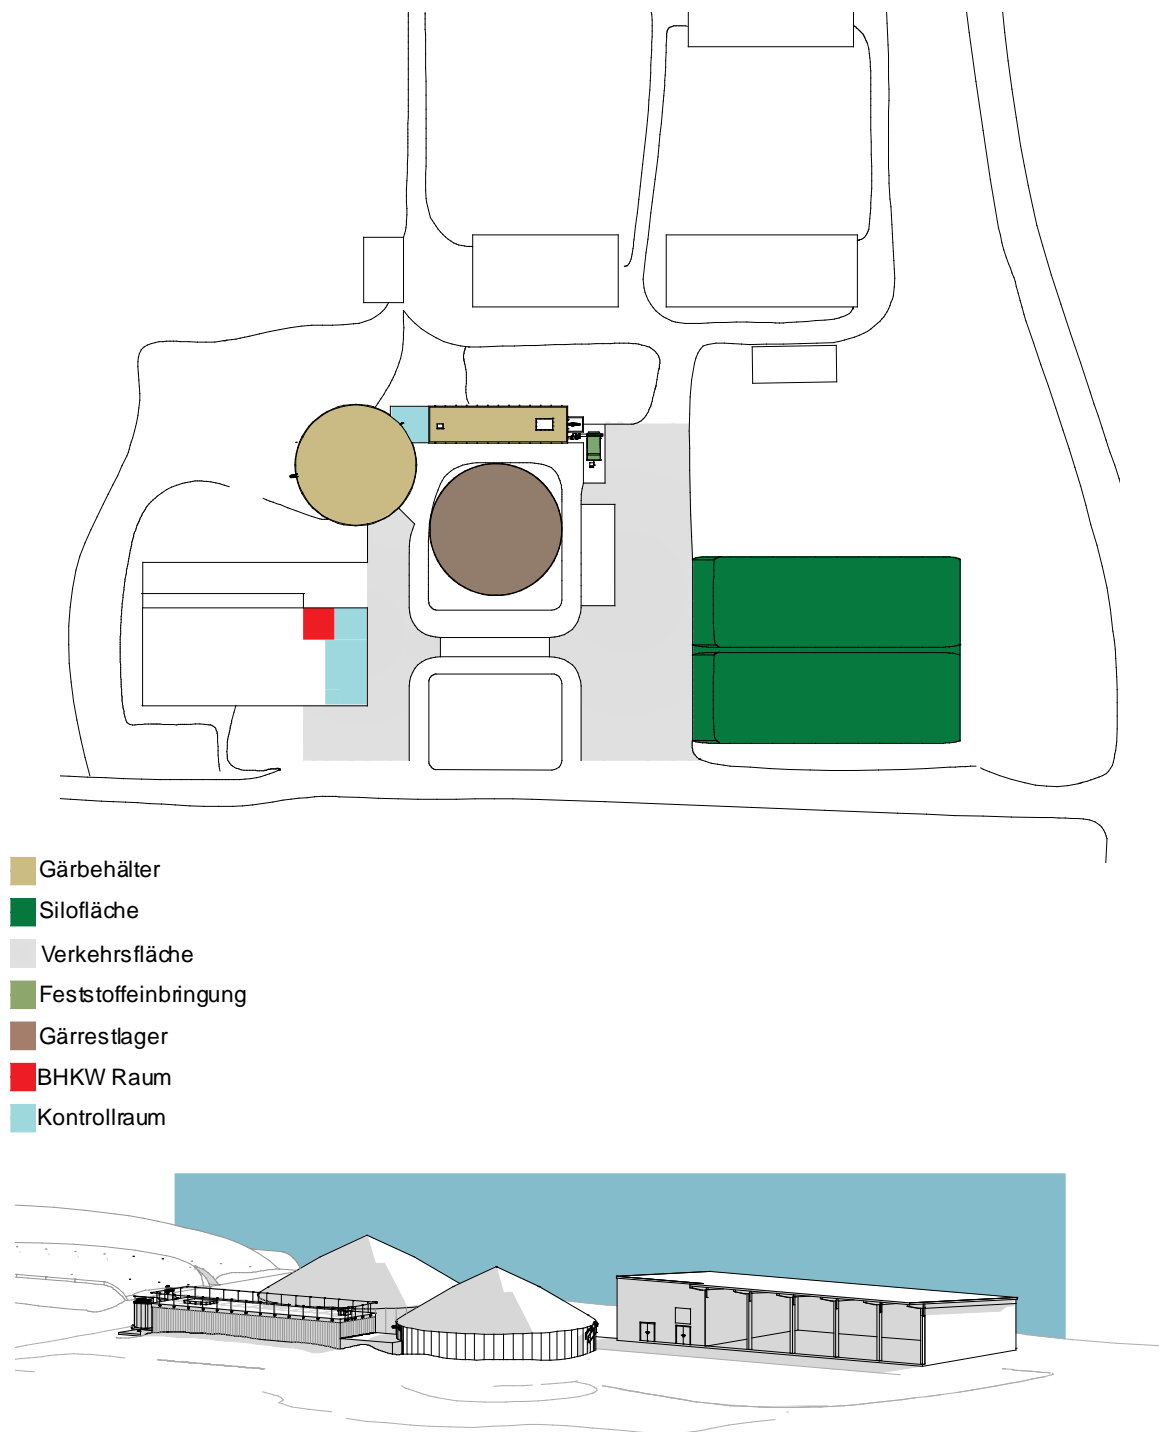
Grundriss und isometrische Darstellung der Pilotanlage 16
